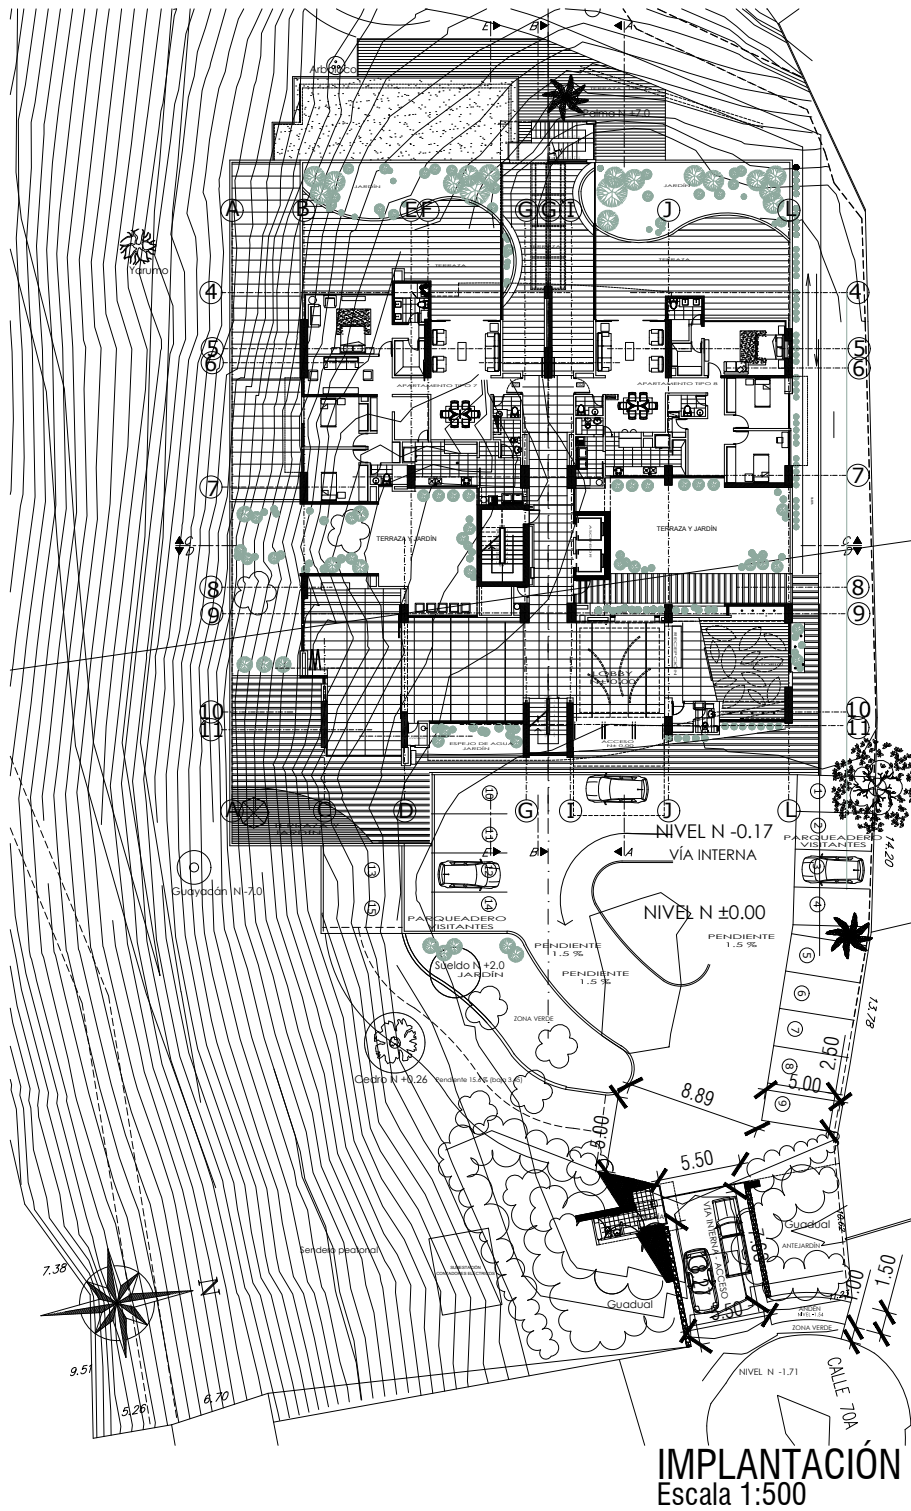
Representación de la planta de localización o implantación de un proyecto arquitectónico
